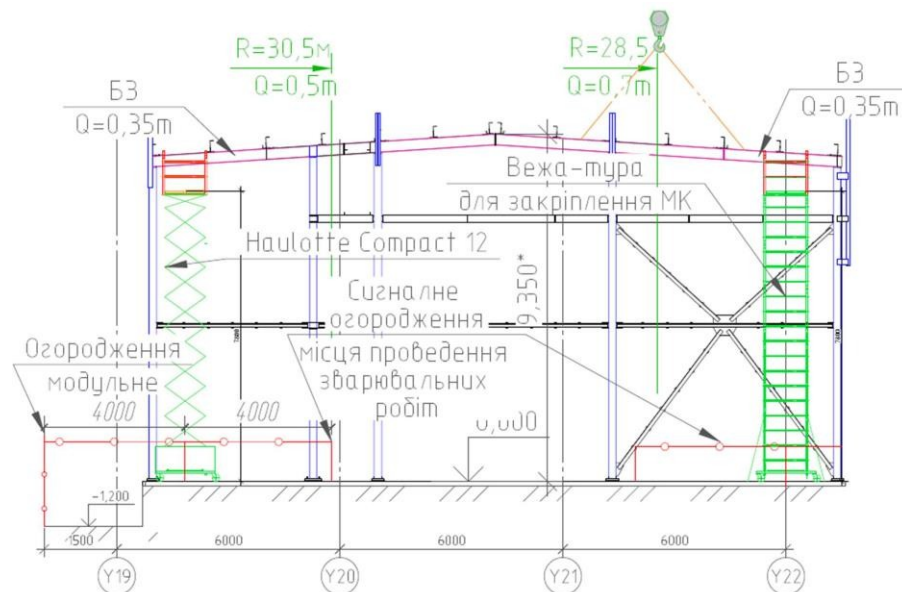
Схема монтажу балки БЗ в осях
